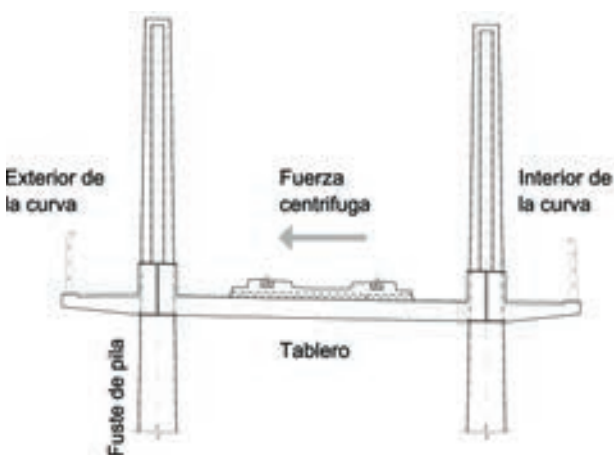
Pórtico formado por los fustes de una pila y el tablero del puente
